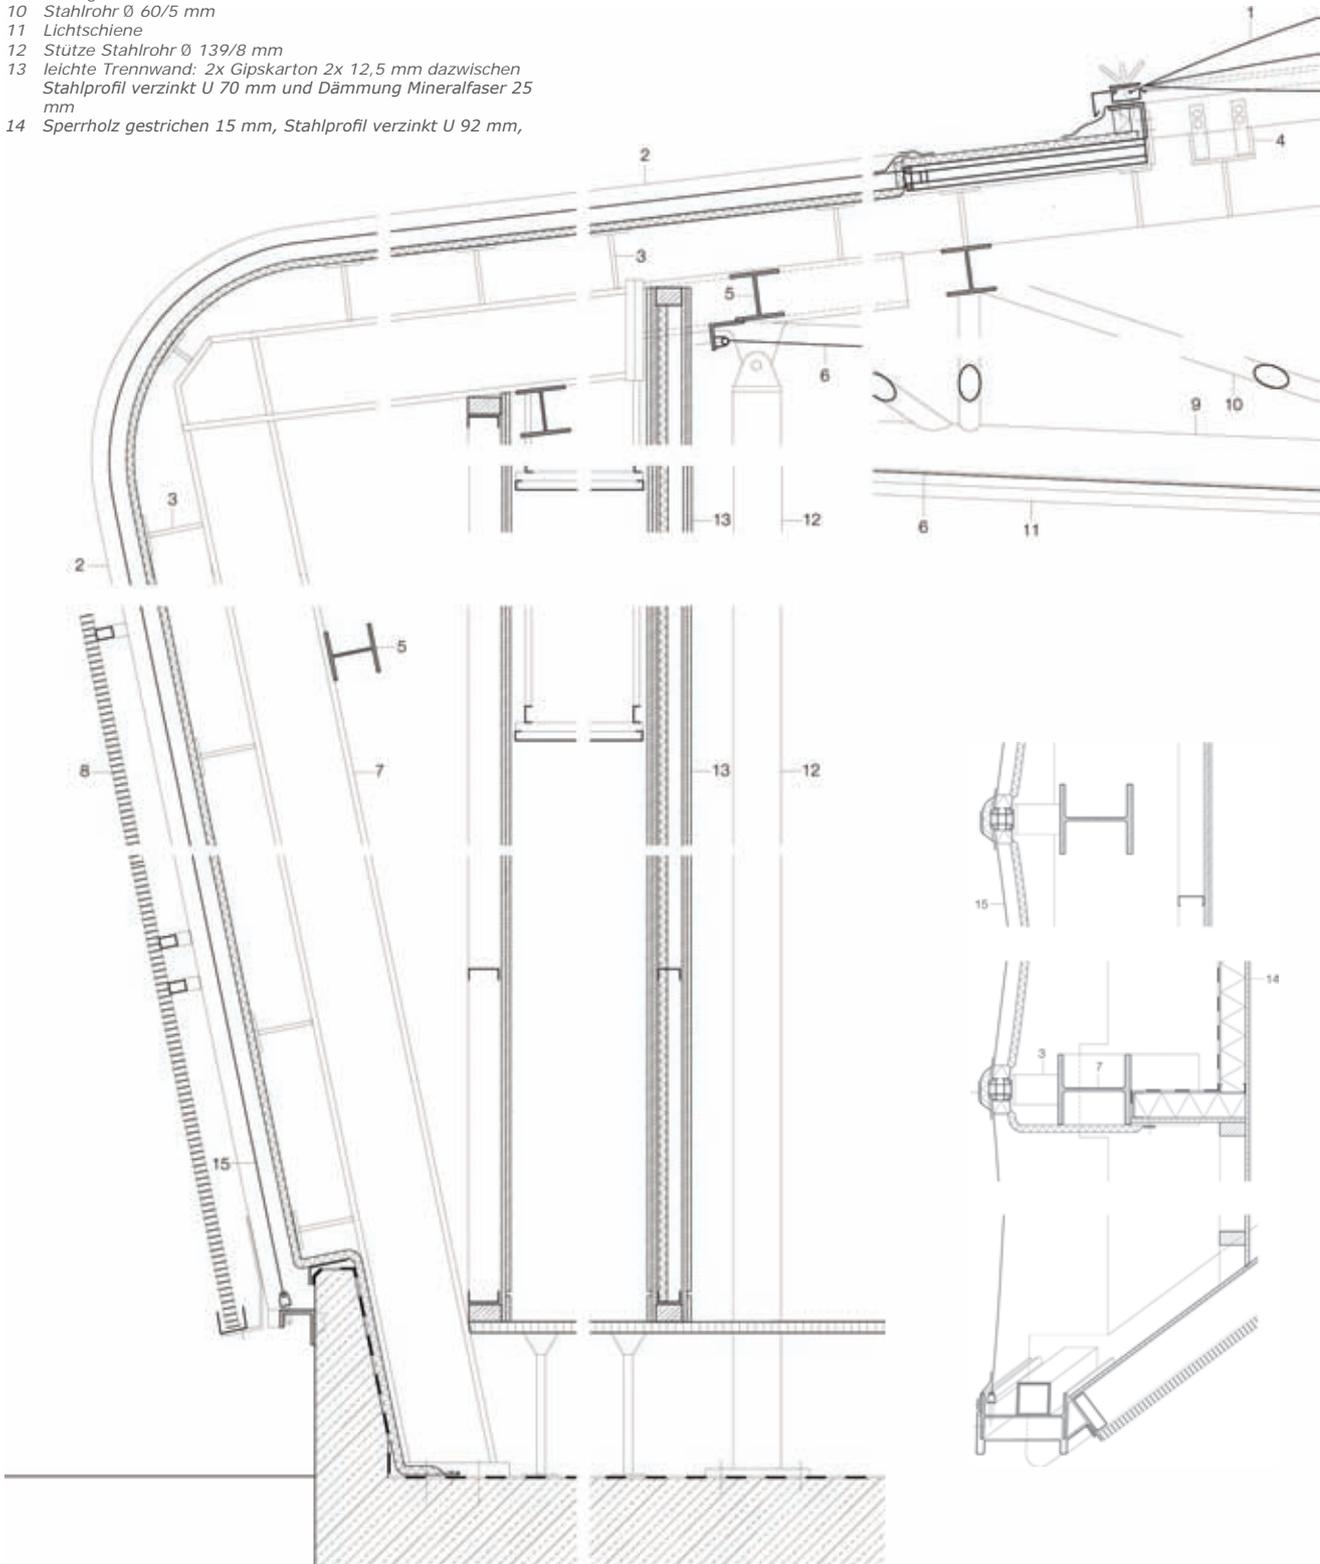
Fasadenschnitt Temporäre Stadtteilverwaltung, London
